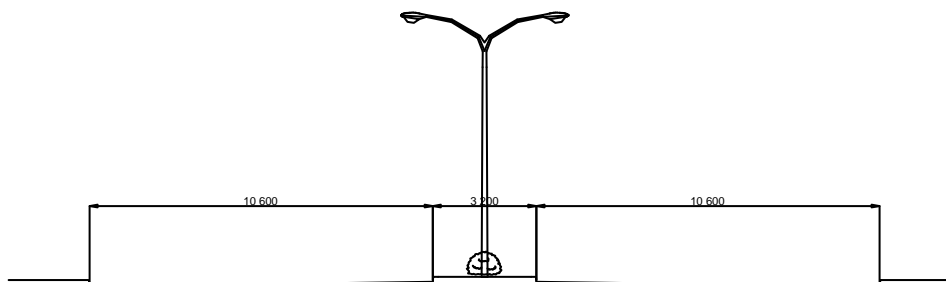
(2) Corte Transversal Existente na Vila de Malema
